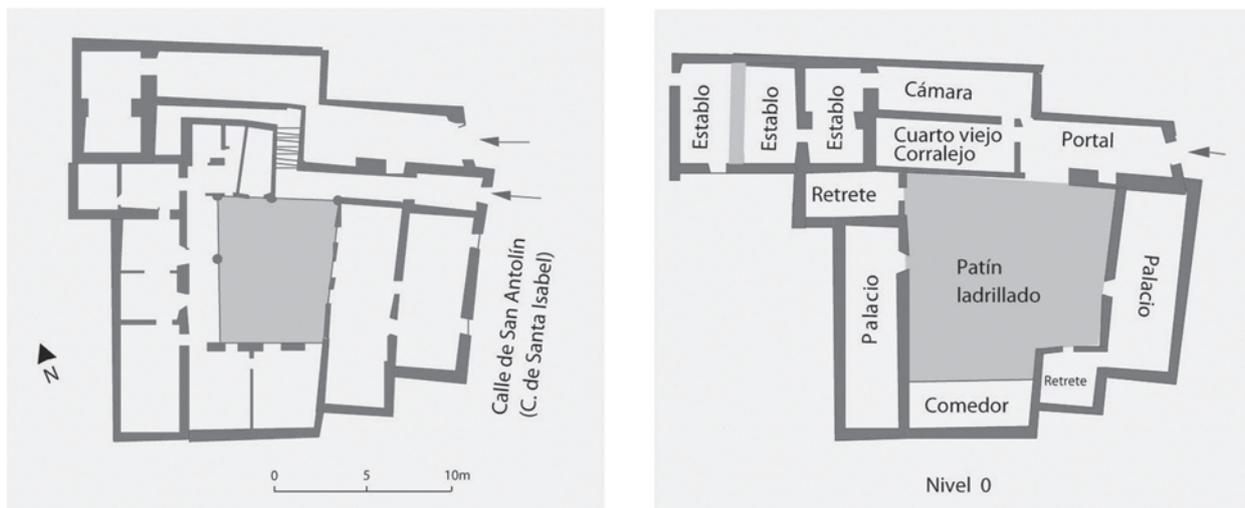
Calle de Santa Isabel, 14: plan actuel, restitution et planimétrie de la maison F-5.
